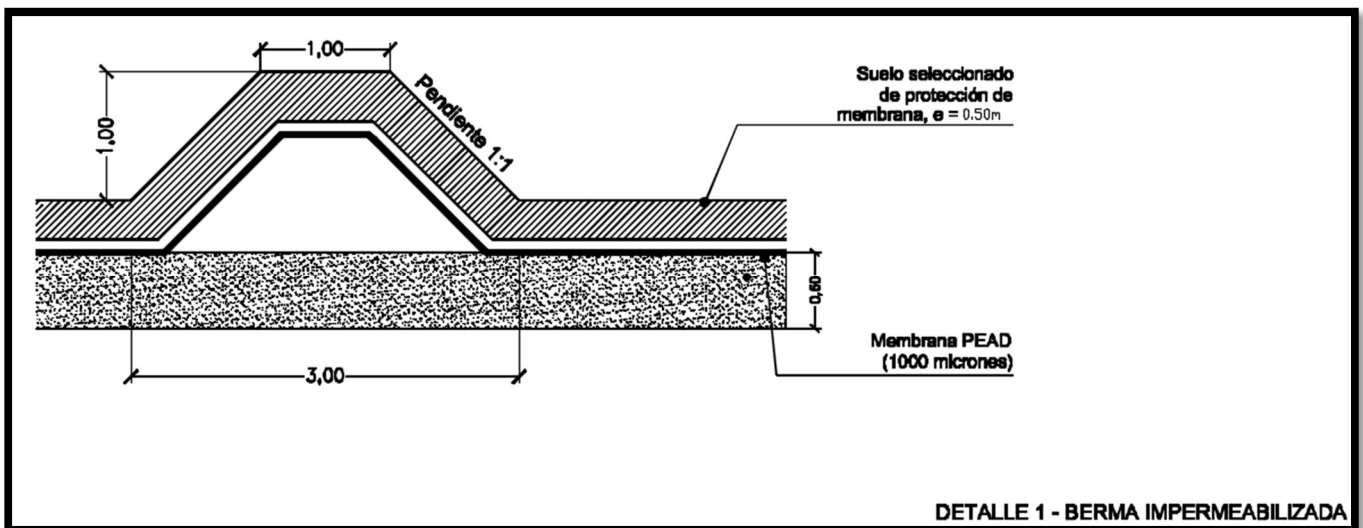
Plano Detalle Berma entre Celdas – Fuente: Elaboración Propia
